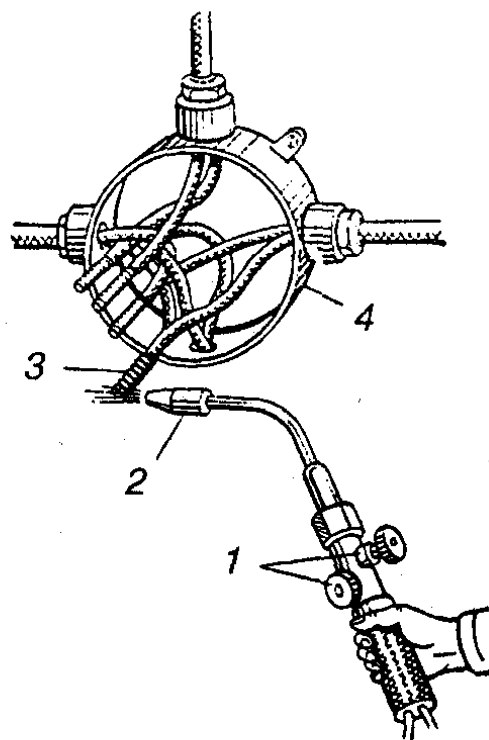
Пропано-кислородная сварка алюминиевых жил суммарным сечением до 35 мм²:
